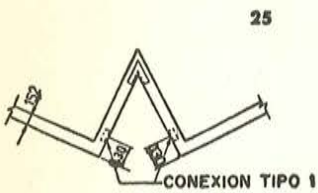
Unión entre las vigas de cubierta del edificio.
